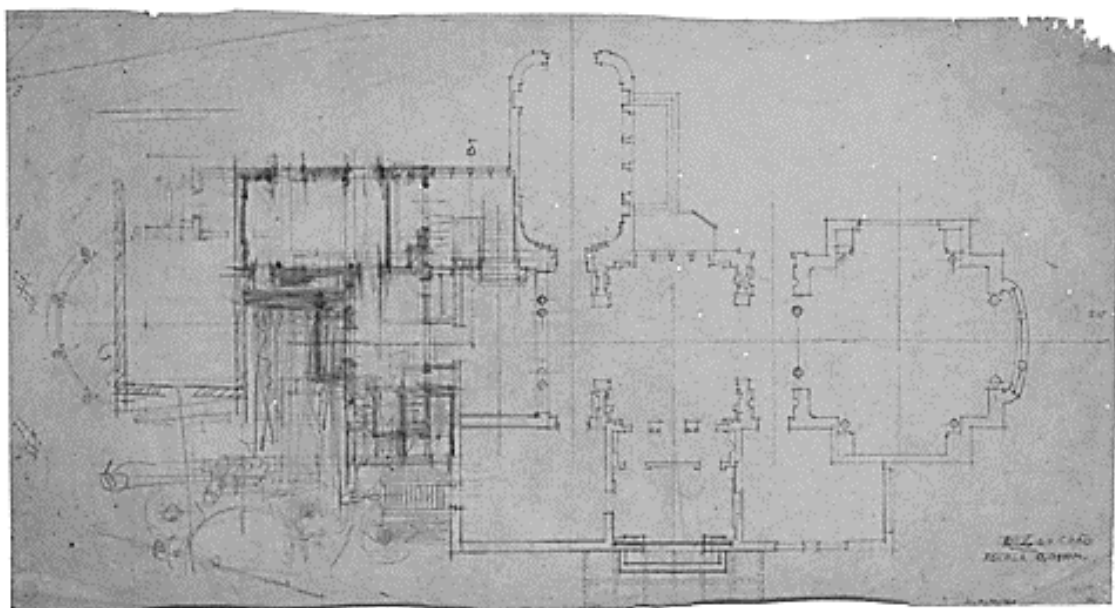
Estudo da Planta dos Grandes Armazéns Nascimento, Marques da Silva
